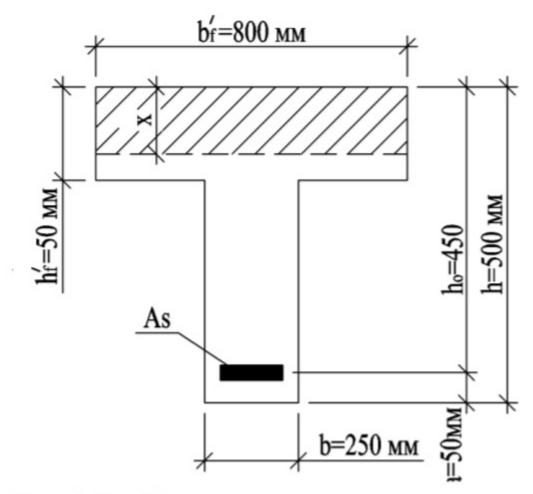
Тавровое сечение элемента с одиночной арматурой
